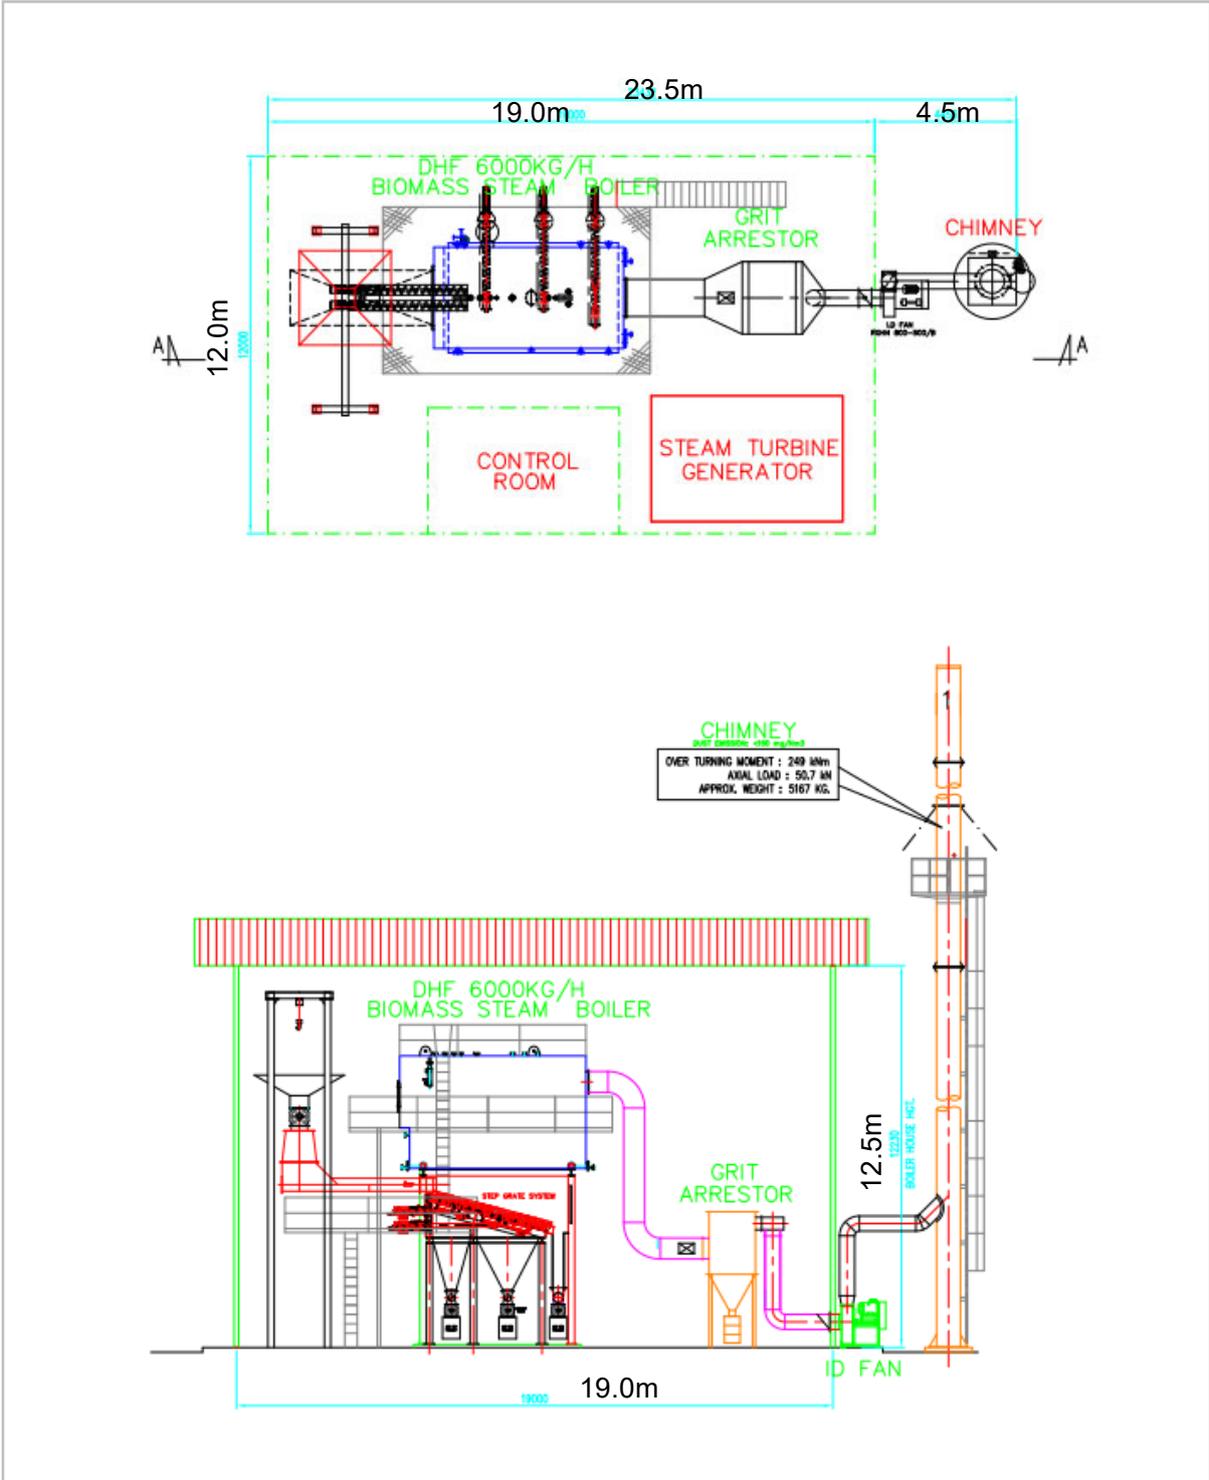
施設平面図・立面図(直接燃烧方式 500kW)
